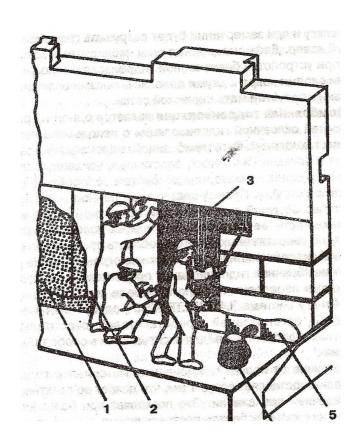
Вертикальная оклеечная гидроизоляция: 1 — первый слой изоляции; 2- второй слой изоляции; 3 - нанесение мастики; 4 - бачок с мастикой; 5 - выпуск ковра горизонтальной гидроизоляции
